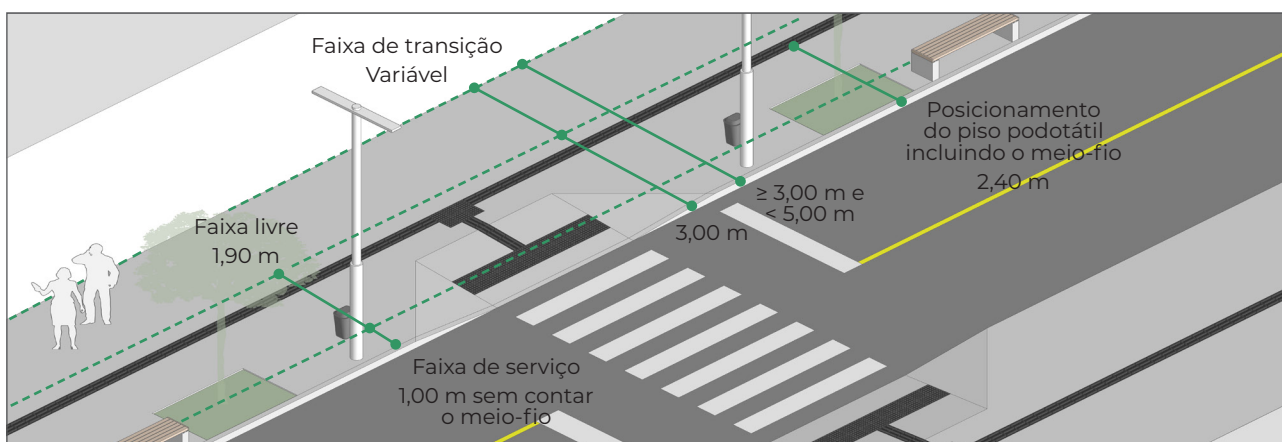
Faixa livre, faixa de serviço, faixa de transição e posicionamento do piso tátil em calçadas com largura igual ou superior a 3,00 m e inferior a 5,00 m.
